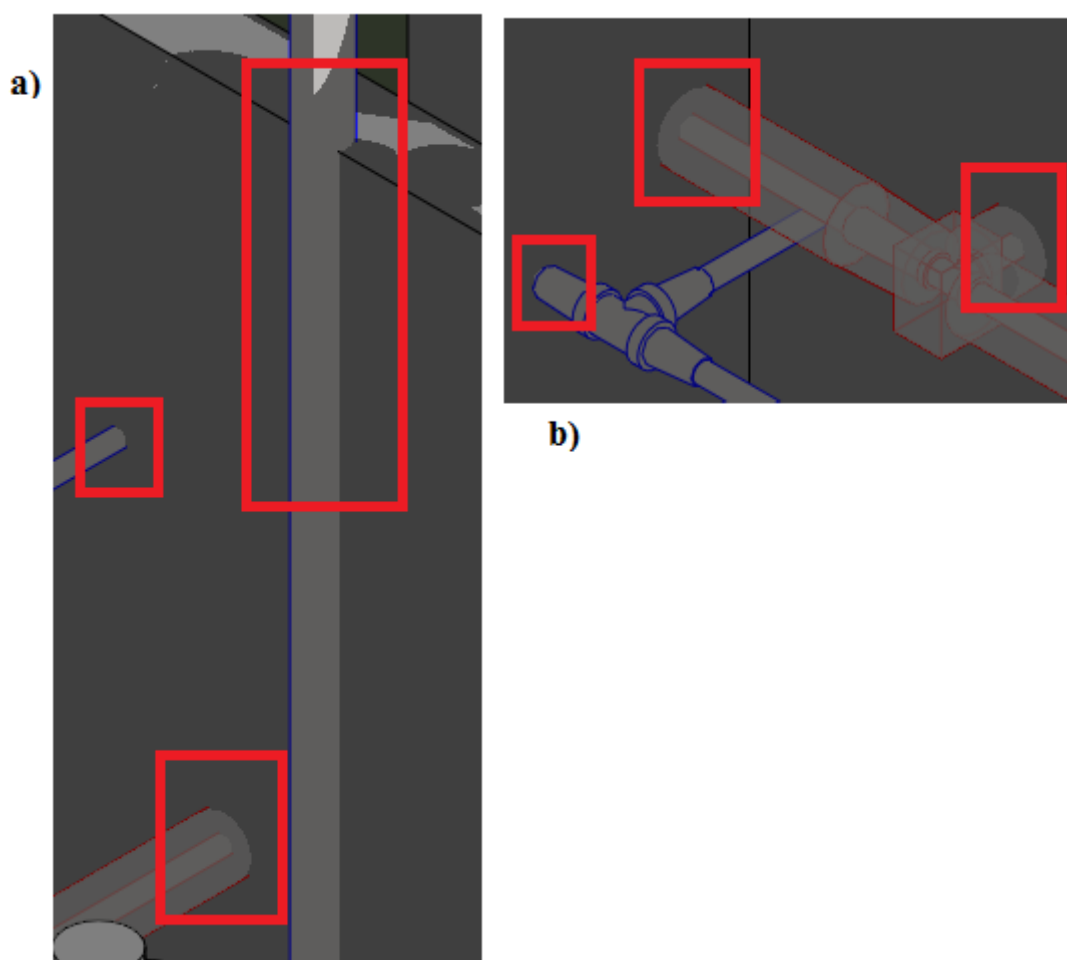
a) e b) Exemplos de painéis sandwich atravessados transversalmente por tubagem de abastecimento de água;
